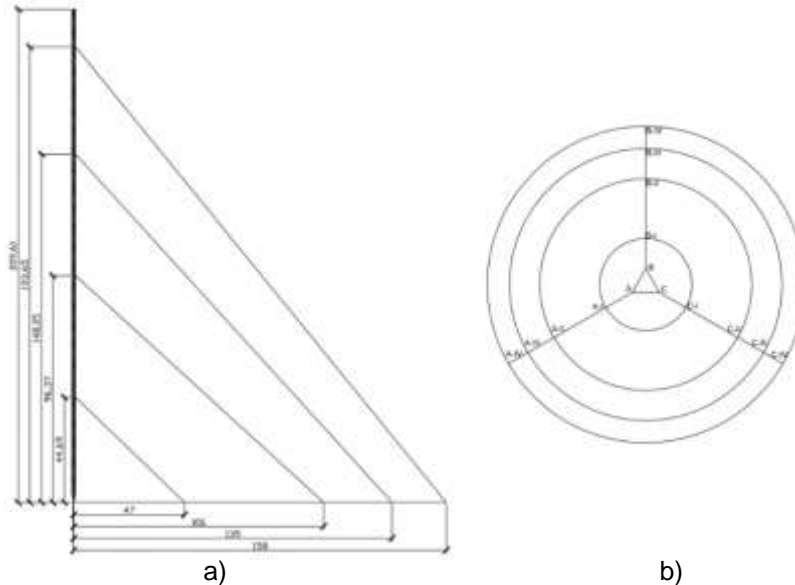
a) Elevación de la torre Televilla b) Planta de la estructura de la torre Televilla.
